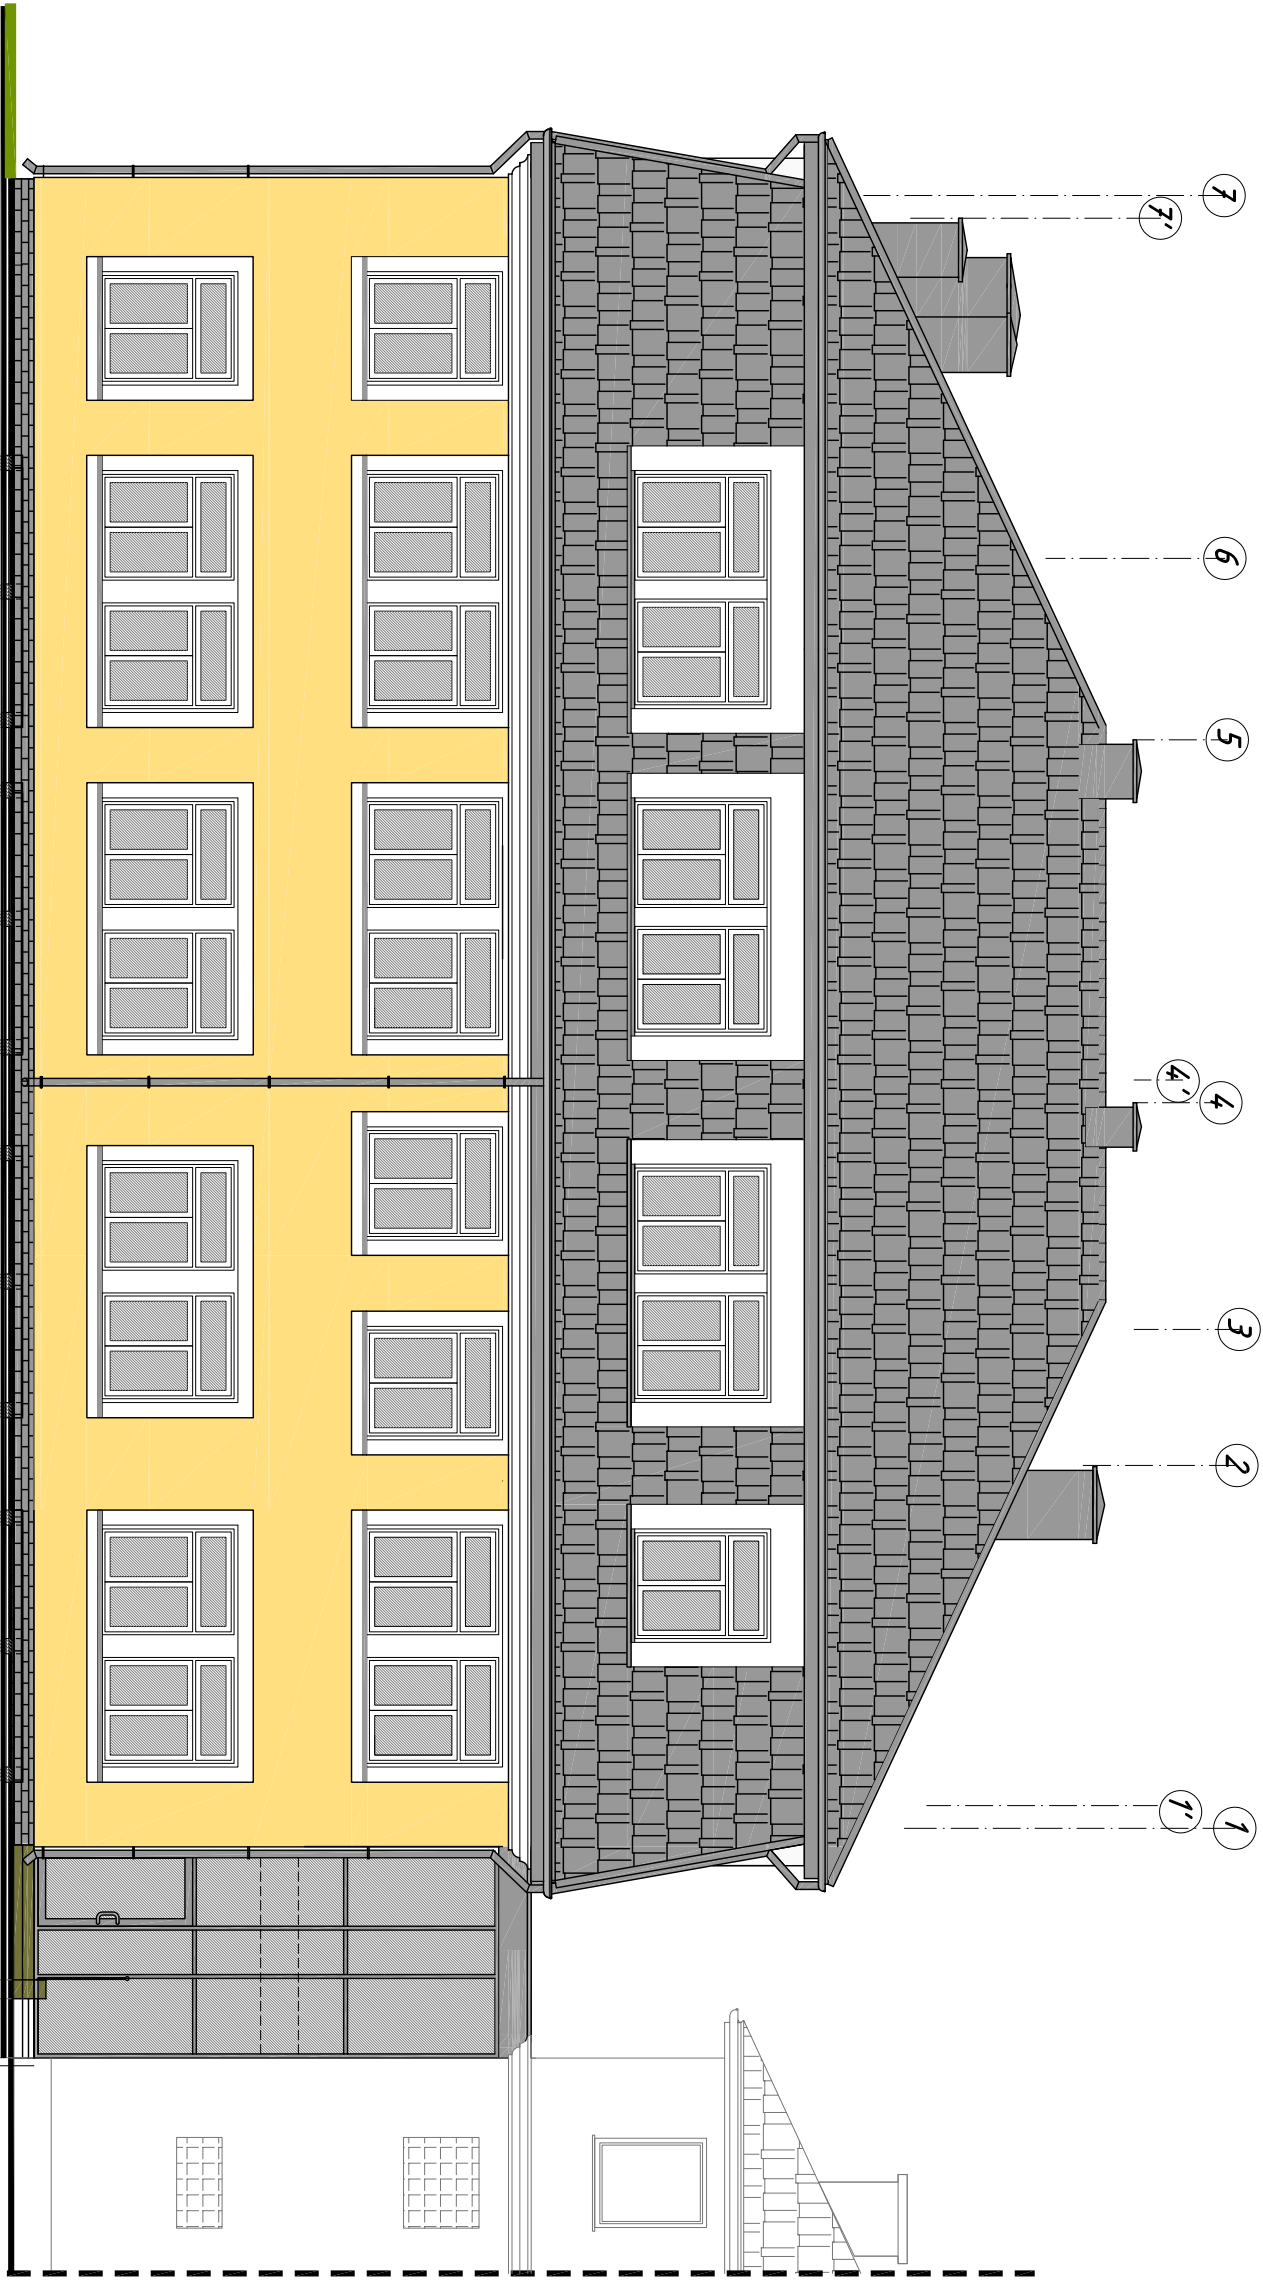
ELEWACJA POŁUDNIOWO-WSCHODNIA (WEJŚCIOWA 2) skala 1:100
